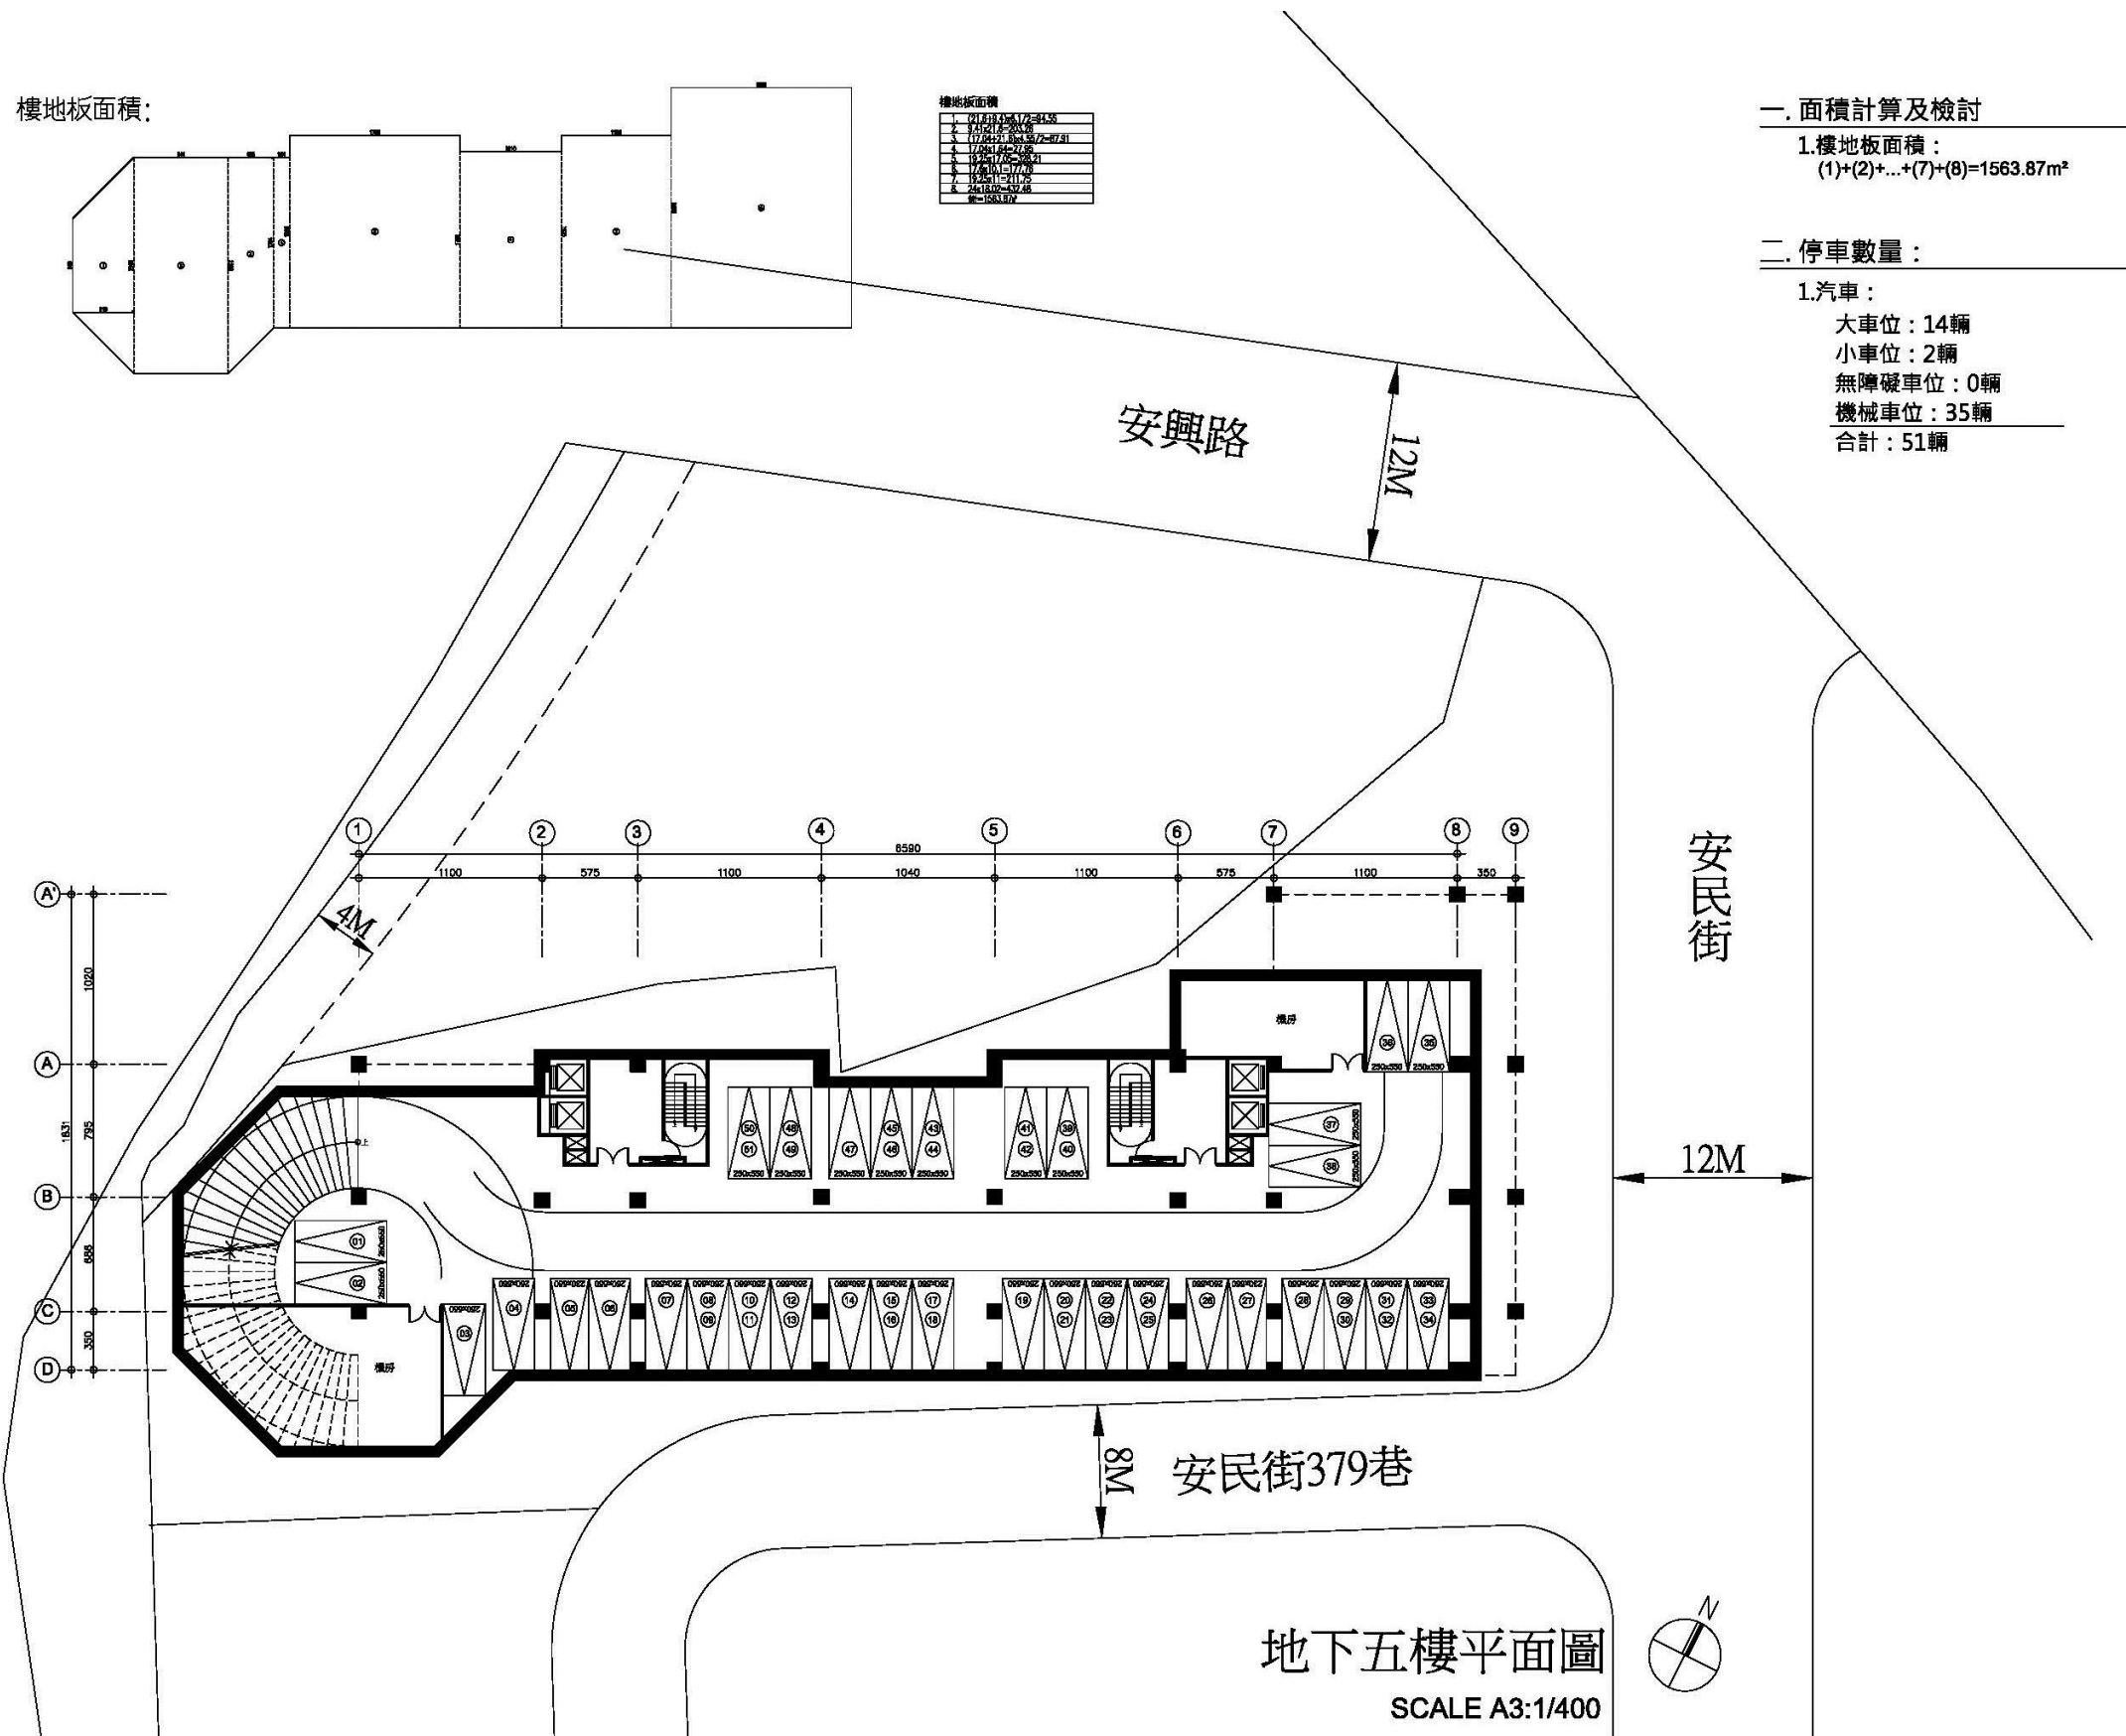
地下五樓平面圖 SCALE:A3:1/400
